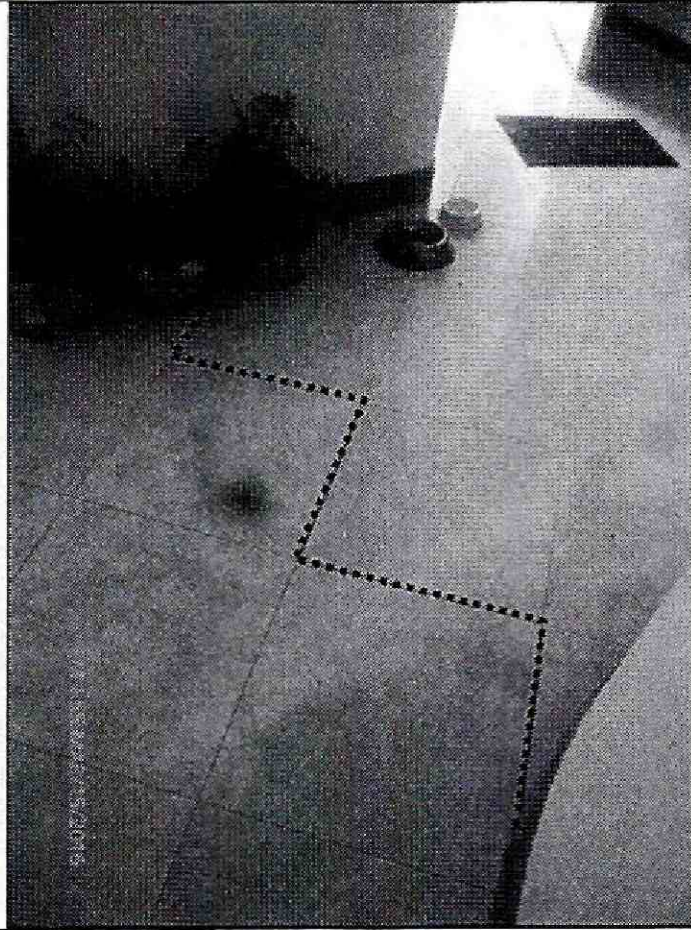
Fisuras identificadas en muro de cerramiento del costado oriental de la edificación ubicada predio de la Calle 84 No. 21 – 26, en el Sector Catastral Polo Club de la Localidad Barrios Unidos.
